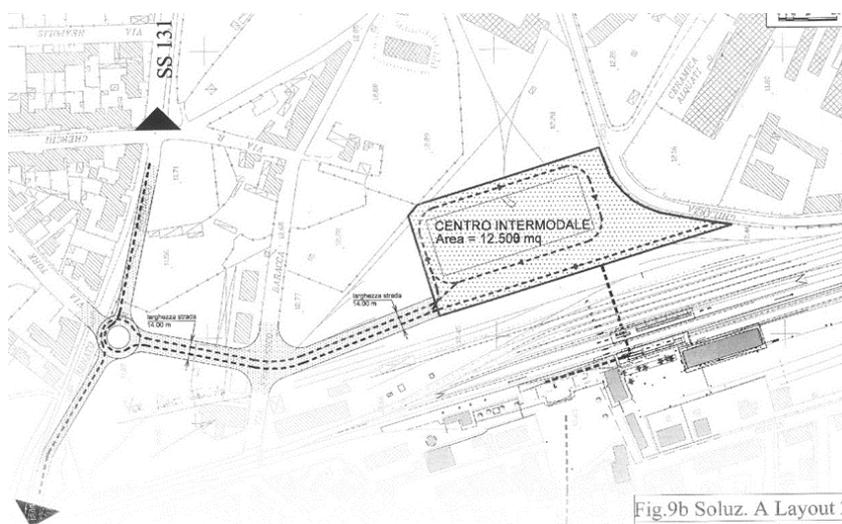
Ipotesi viabilità d'accesso Centro Intermodale
